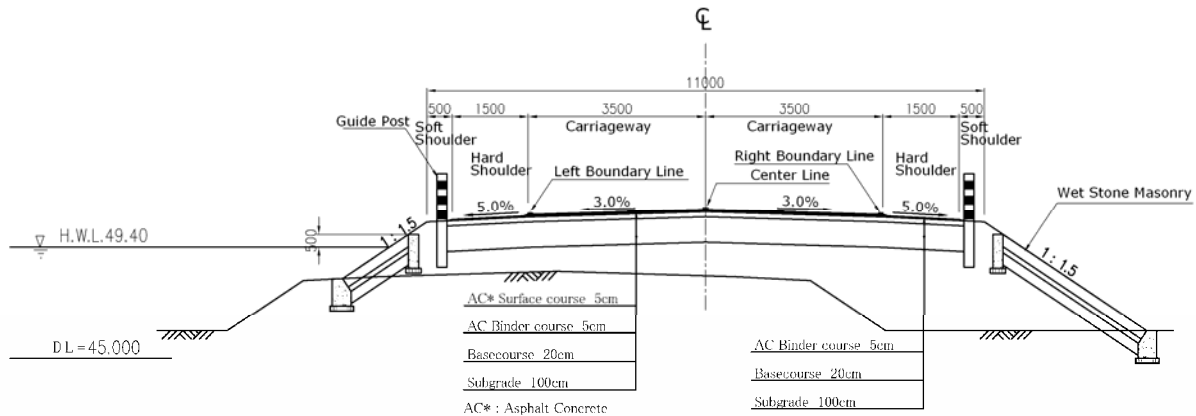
Profil en travers-type de la voie d'accès au pont Soumba
